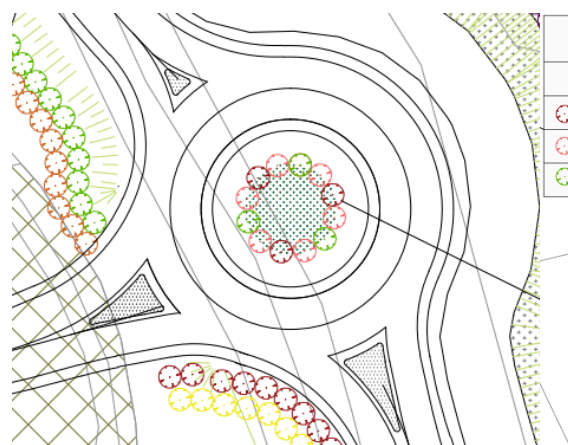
Estratto Elaborato P00_IA00_AMB_PP01 Planimetria opere a verde
